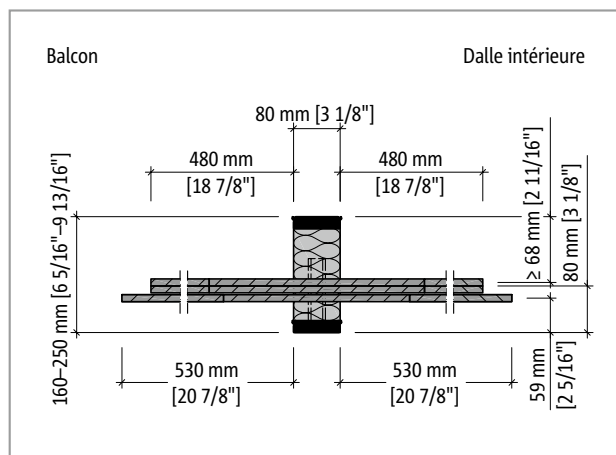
Schöck Isokorb® T Type CH-VV2-NN1 : coupe transversale du produit
